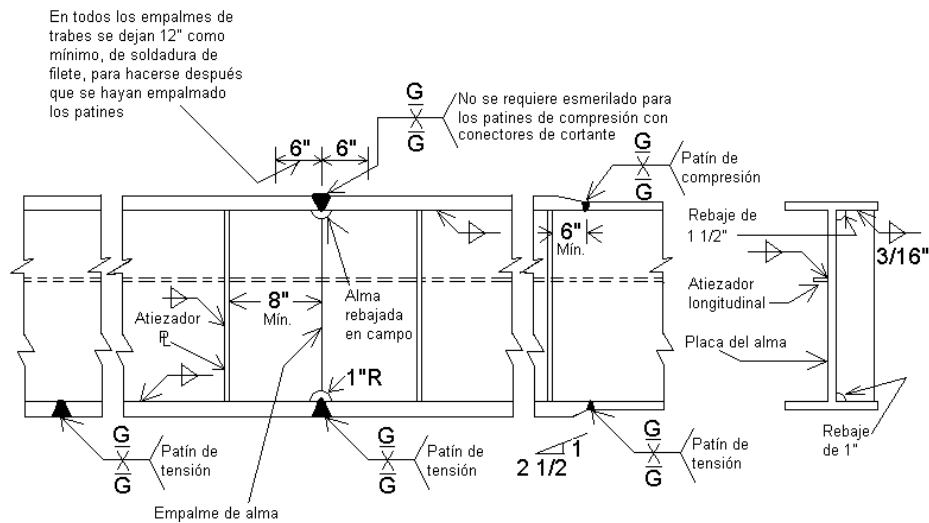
Detalles típicos de traveses soldados
